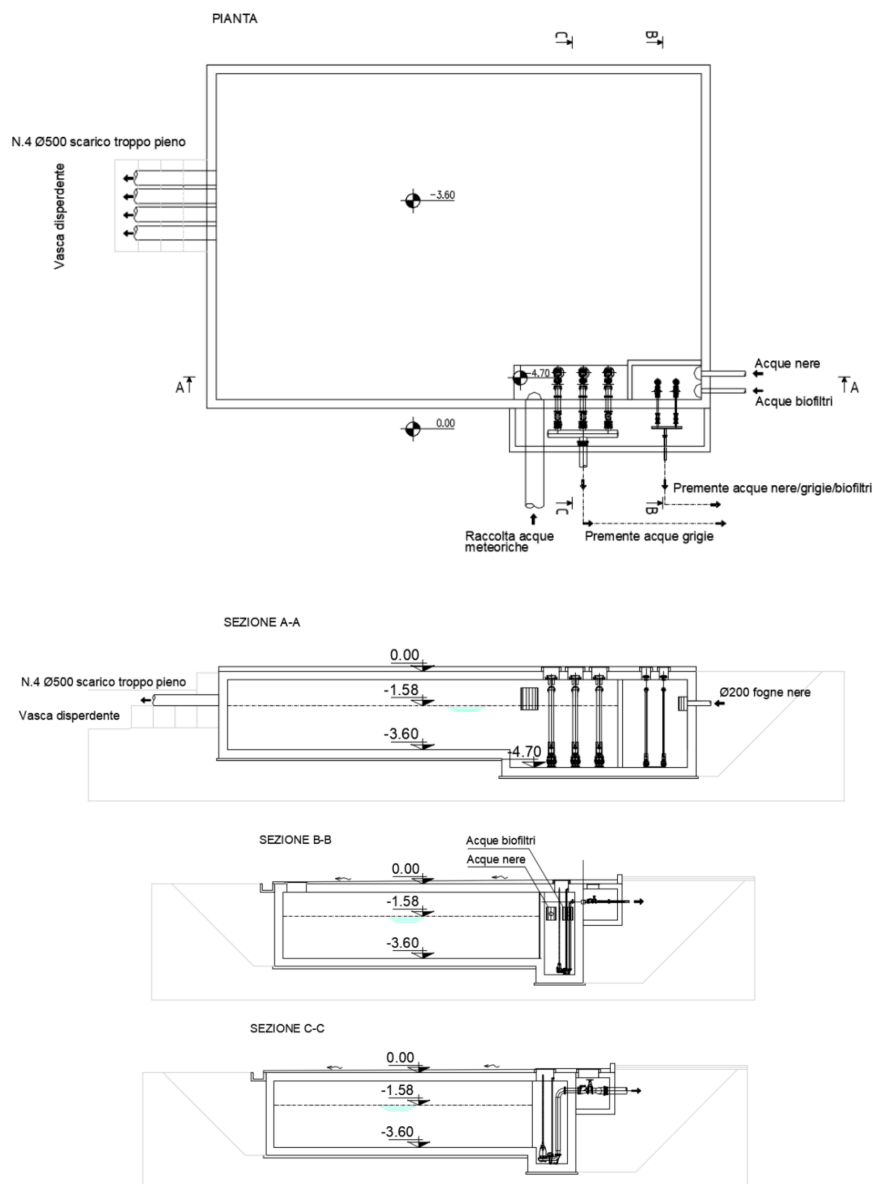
Vasca di laminazione – Pianta e sezioni schematiche
